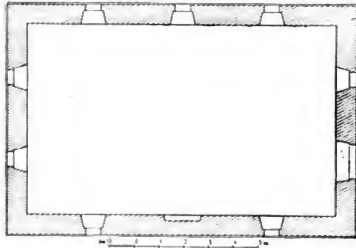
Mšeno. Grundriss der Johanniskirche.
